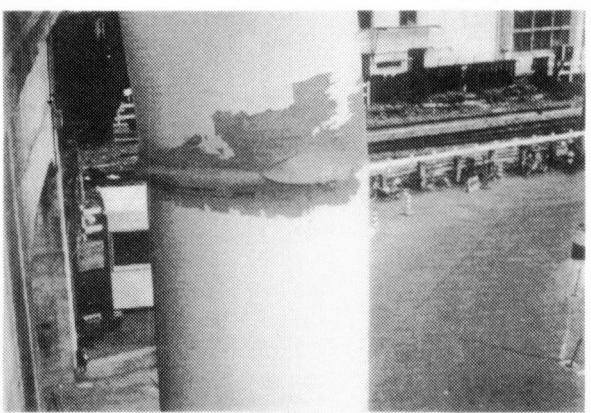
1. 2-8 鋼製橋脚の座屈（円形断面）
